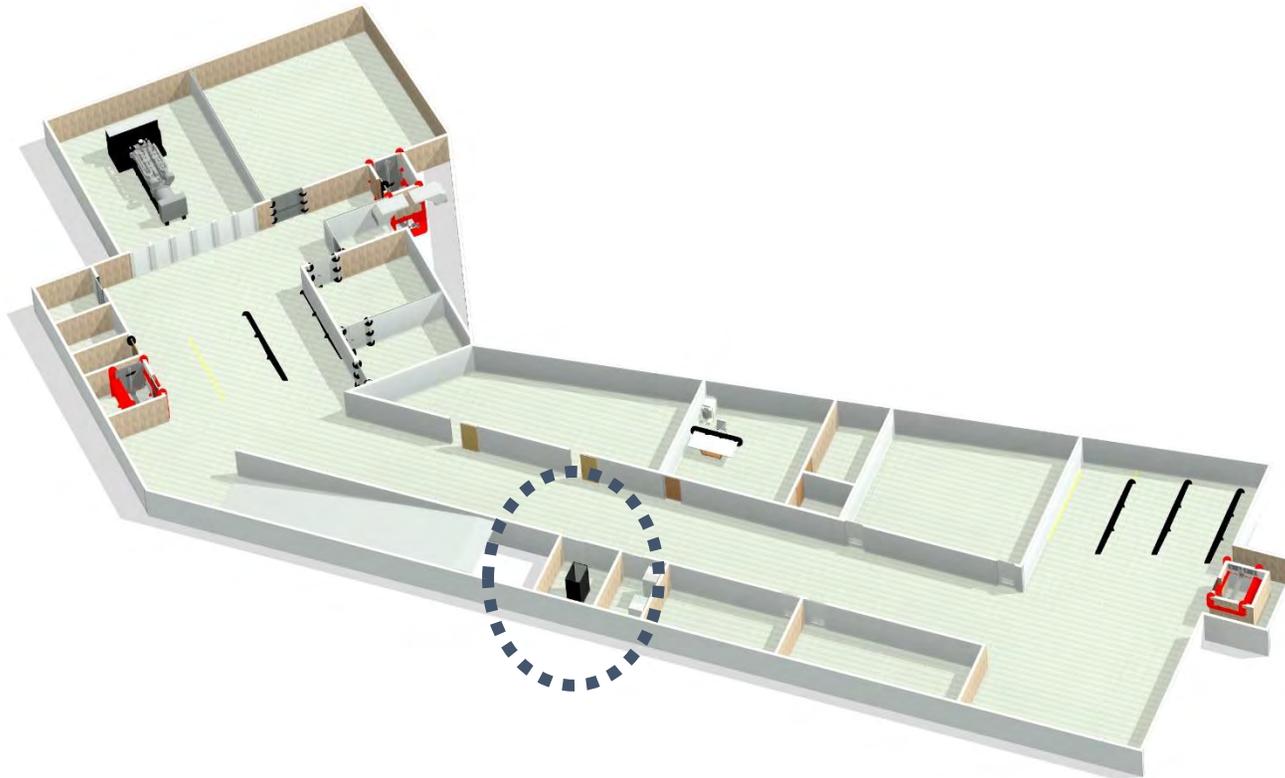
Planta de distribución arquitectónica Sótano. Elaboración propia, 2020.
